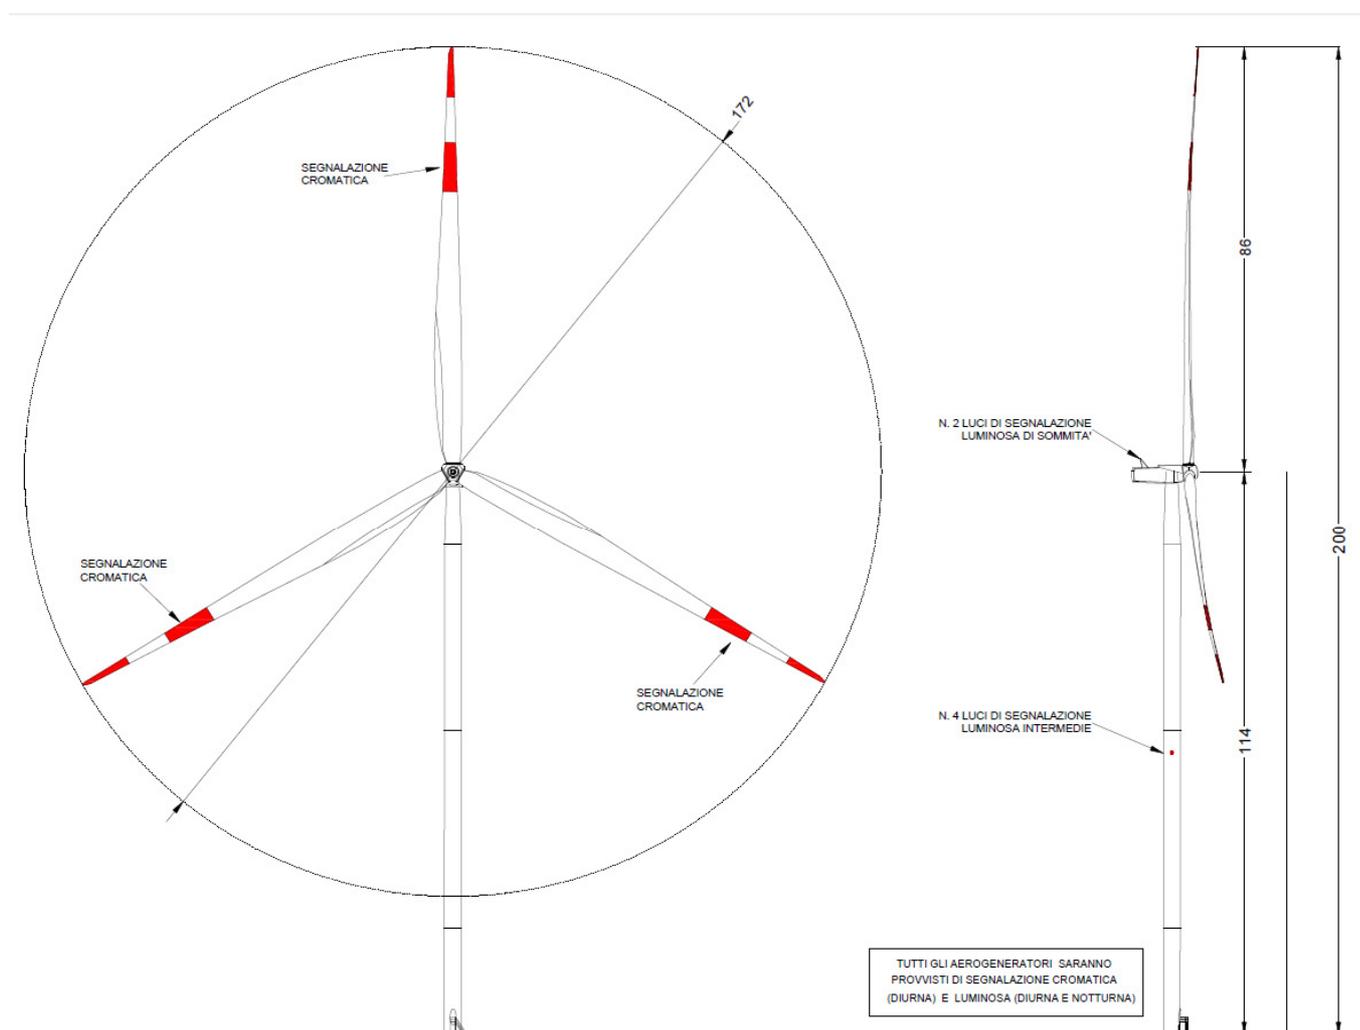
Prospetto e sezione dell'aerogeneratore tipo VESTAS – V172-7.2 MW
